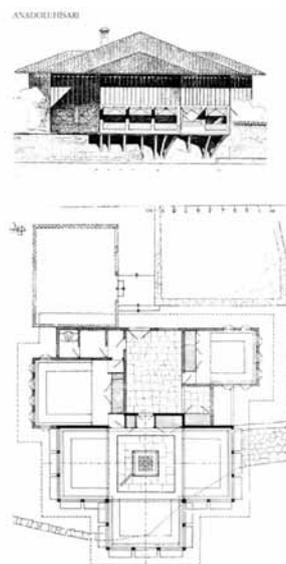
YALI AMCAZADE PLAN ET FACADE.
